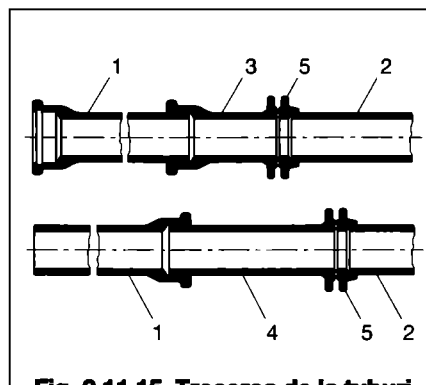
Trecerea de la tuburi din fontă de presiune cu mufă la țevi din oțel, cu flanșe și invers, folosind piese de trecere din fontă și flanșe:
